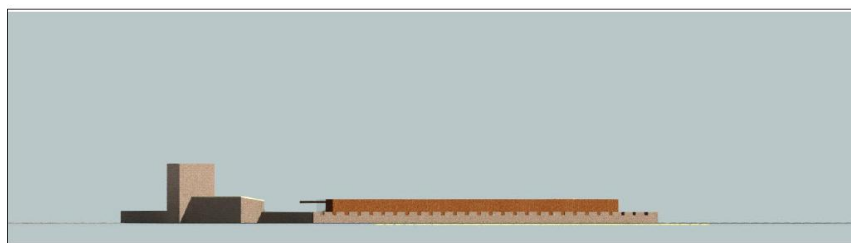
Vista forntal de la solución propuesta. Alzado Noroeste.
